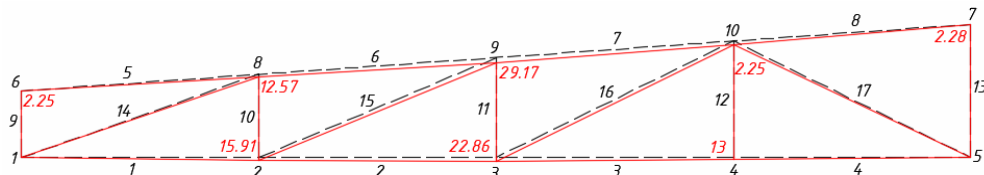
Перемещения узлов фермы, мм, вариант №1
